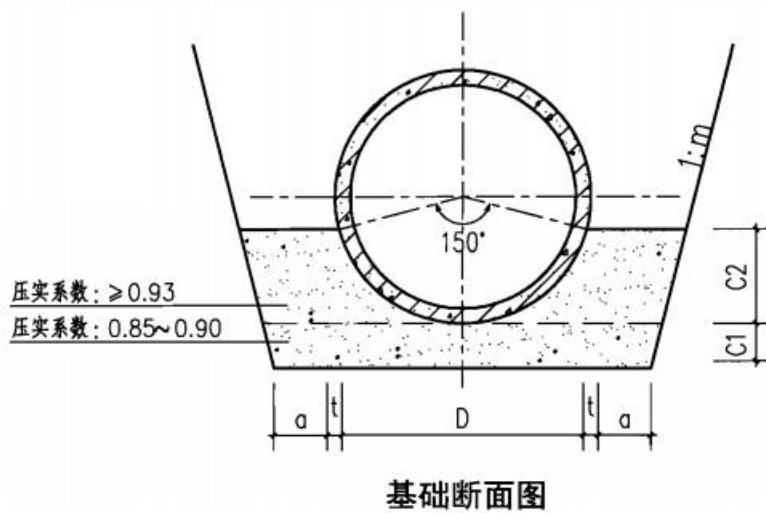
D300 承插口钢筋混凝土管道基础断面图
